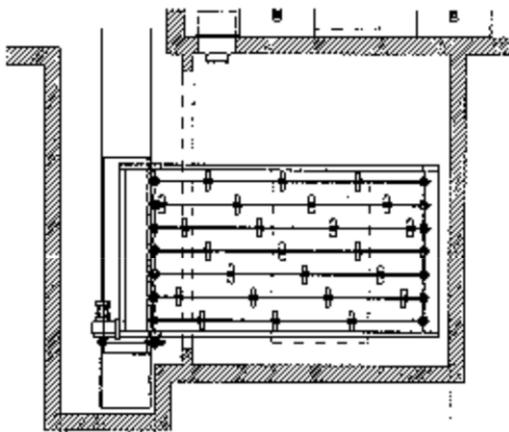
Scarico del silo tramite piano raschiante [66].
